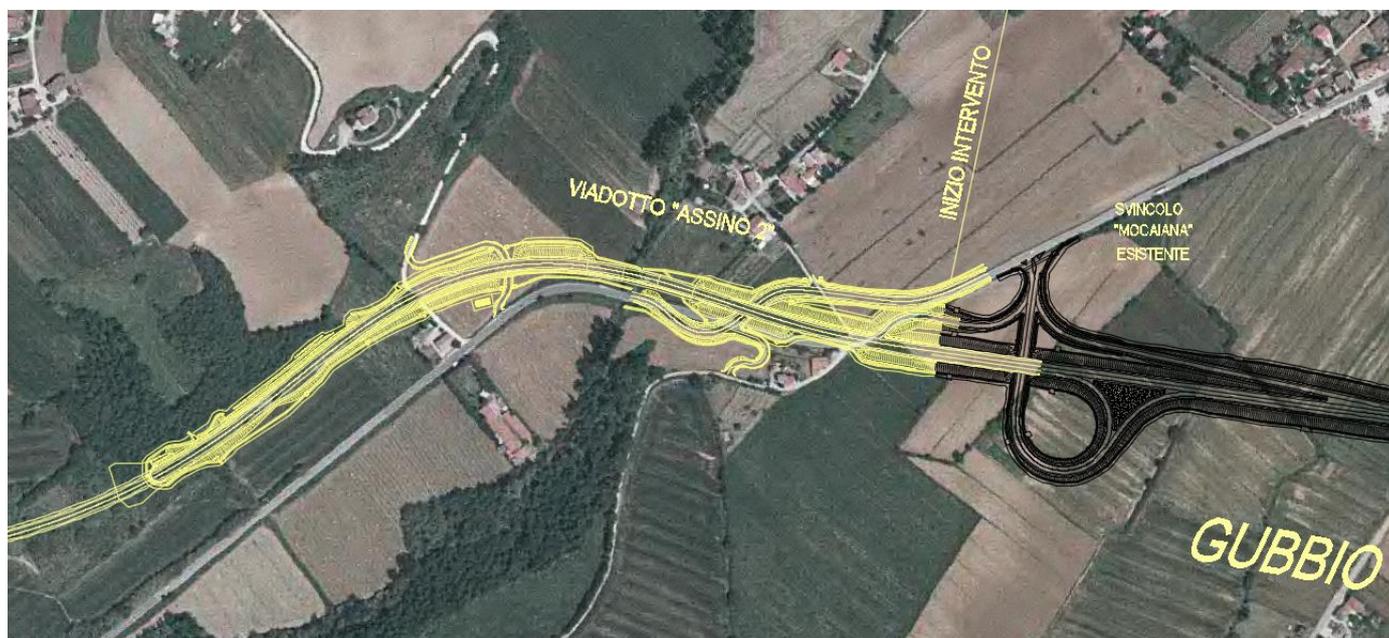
TRATTO DALLA GALLERIA MOLINELLO A FINE LOTTO
